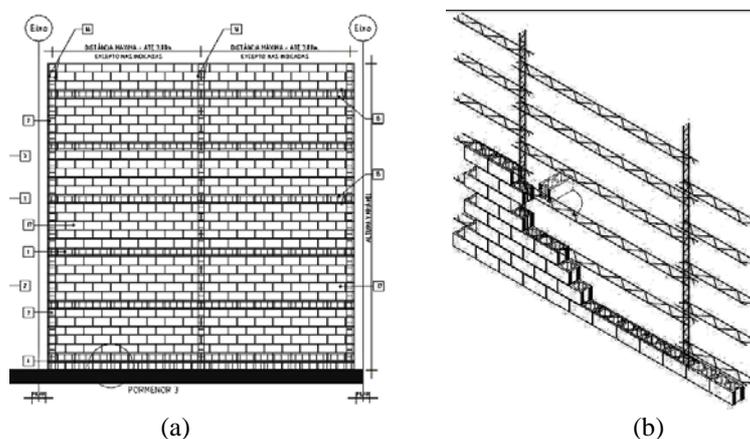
Alvenaria moderna armada (solução típica espanhola com Murfor®). Exemplos de: (a) parede de alvenaria não resistente com cintas e montantes em betão armado; (b) parede não resistente alternativa com sistema de armaduras verticais e horizontais em treliça.
